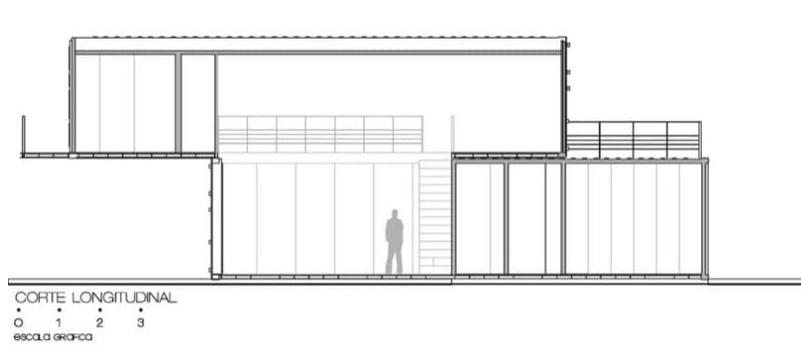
Corte Estructural - Casa Contenedor de Huiini, México
